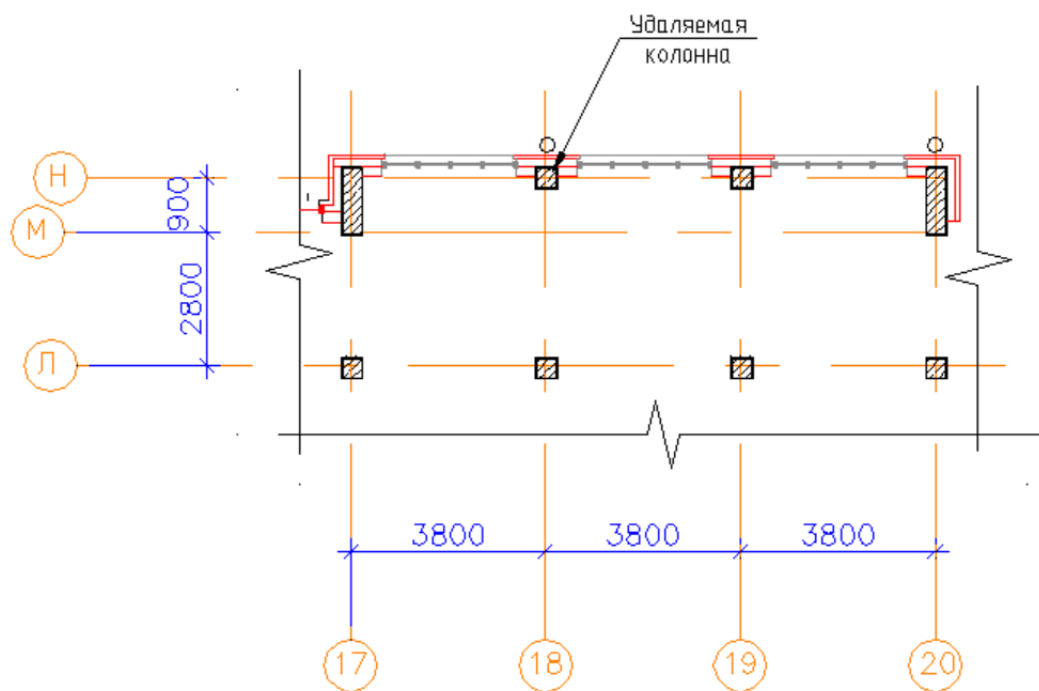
Обозначение на плане 1 этажа удаляемой колонны Н-18
